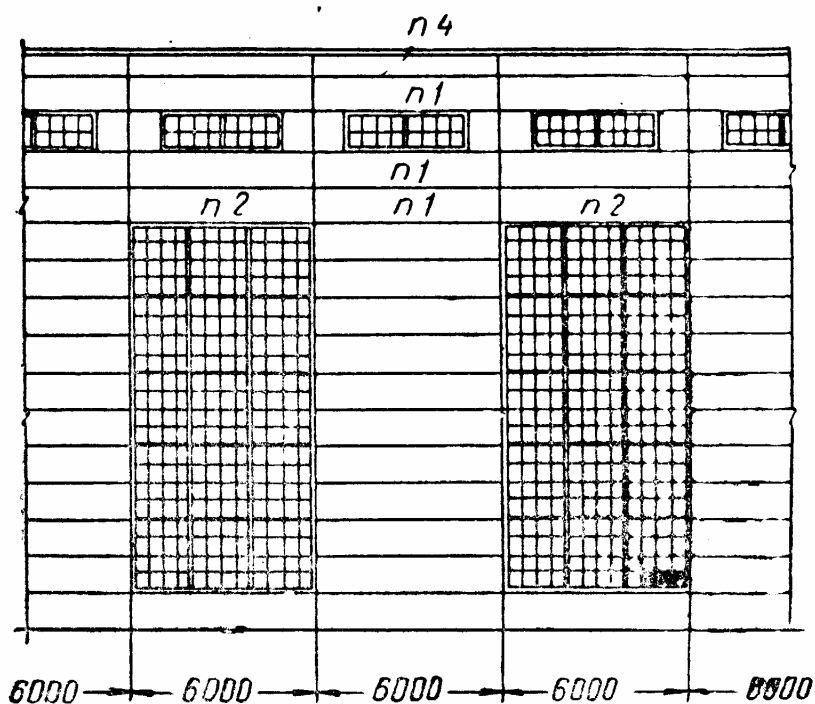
Пример решения фасада производственного здания с наружными панельными стенами и с окнами шириной 6 м
